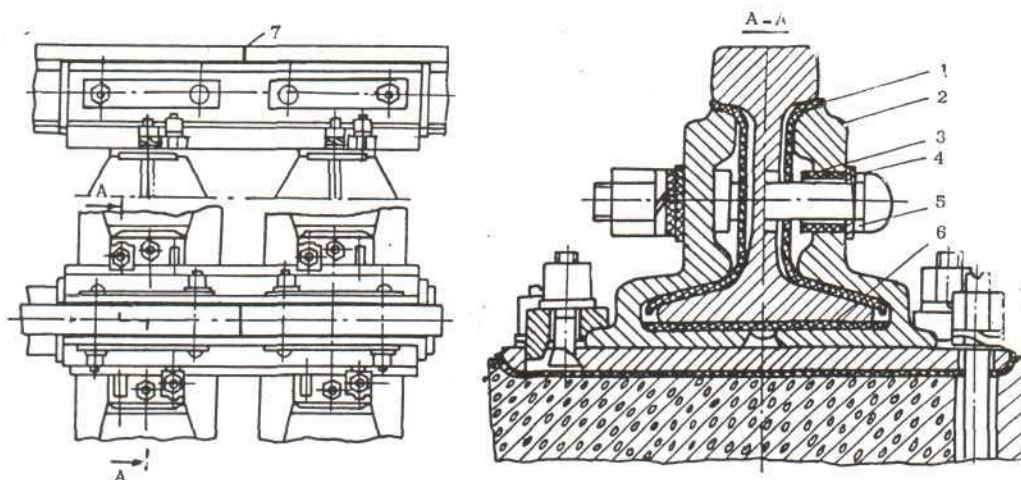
а. Изолирующий стык с объемными накладками на железобетонных шпалах:
